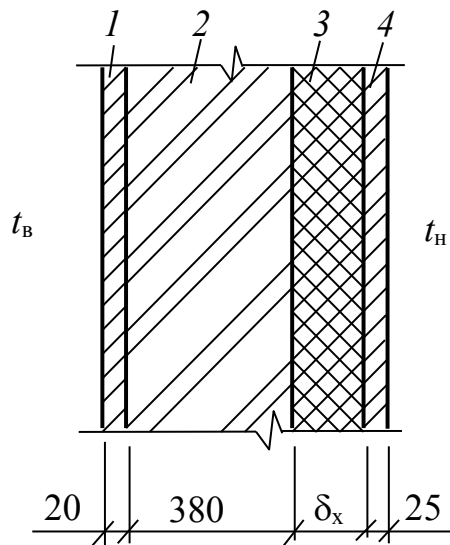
Вариант 3 конструкции наружной стены:
